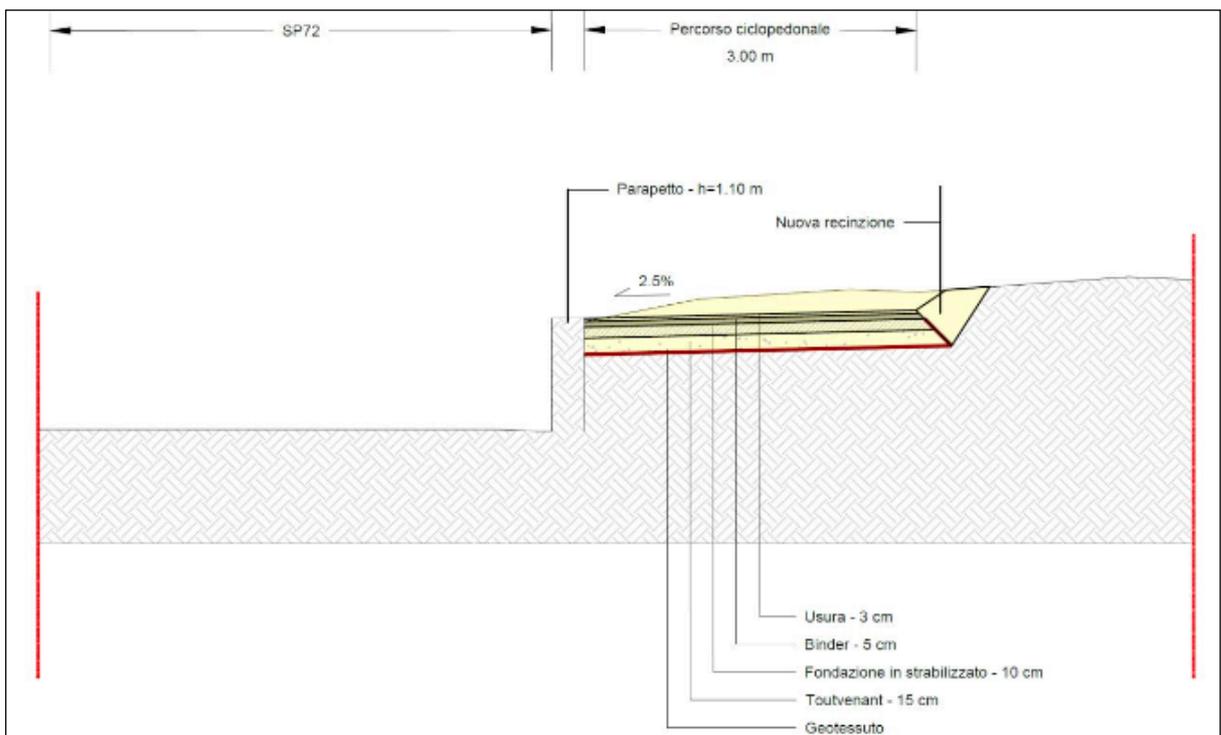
Sezione C31 – Tratto nuova ciclovie su muro
